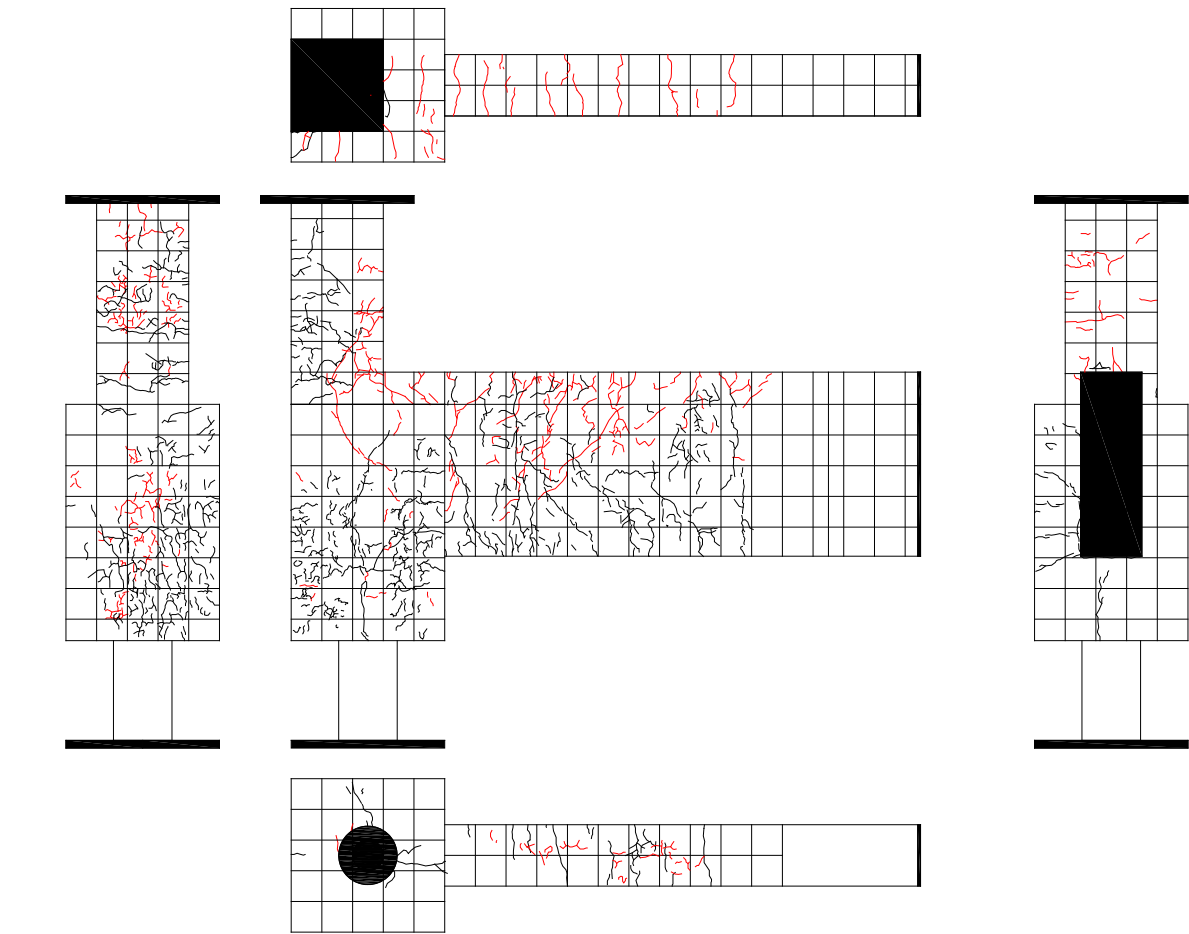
試験体 C-3 ひび割れ状況 (4Cycle)
